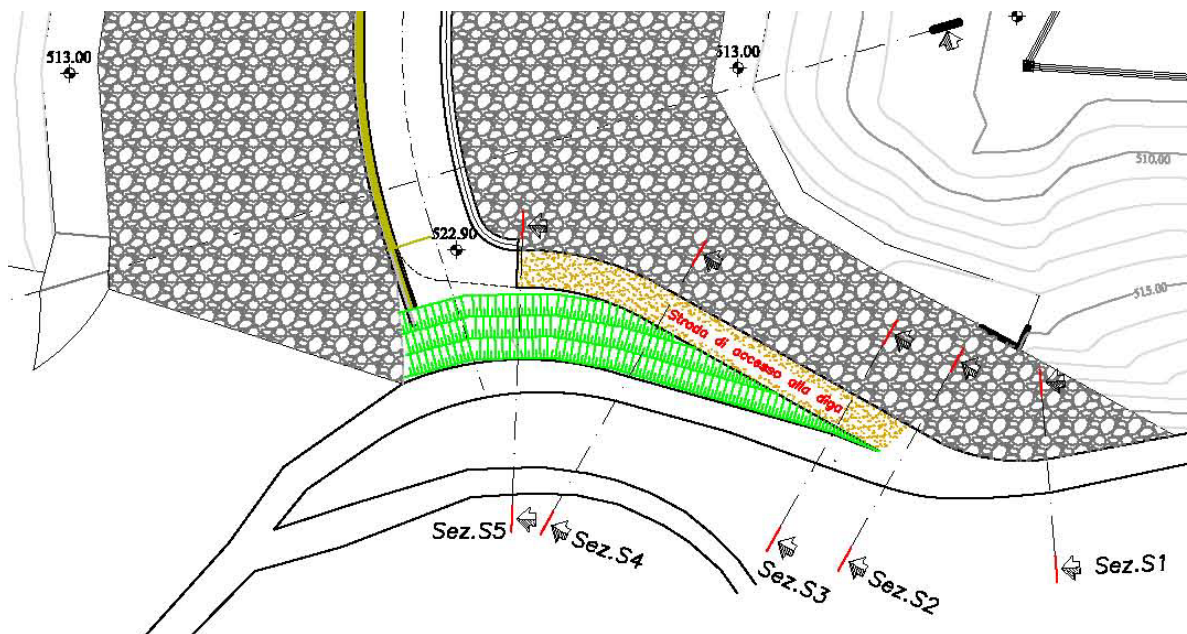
Planimetria con individuazione della nuova strada di accesso al coronamento
